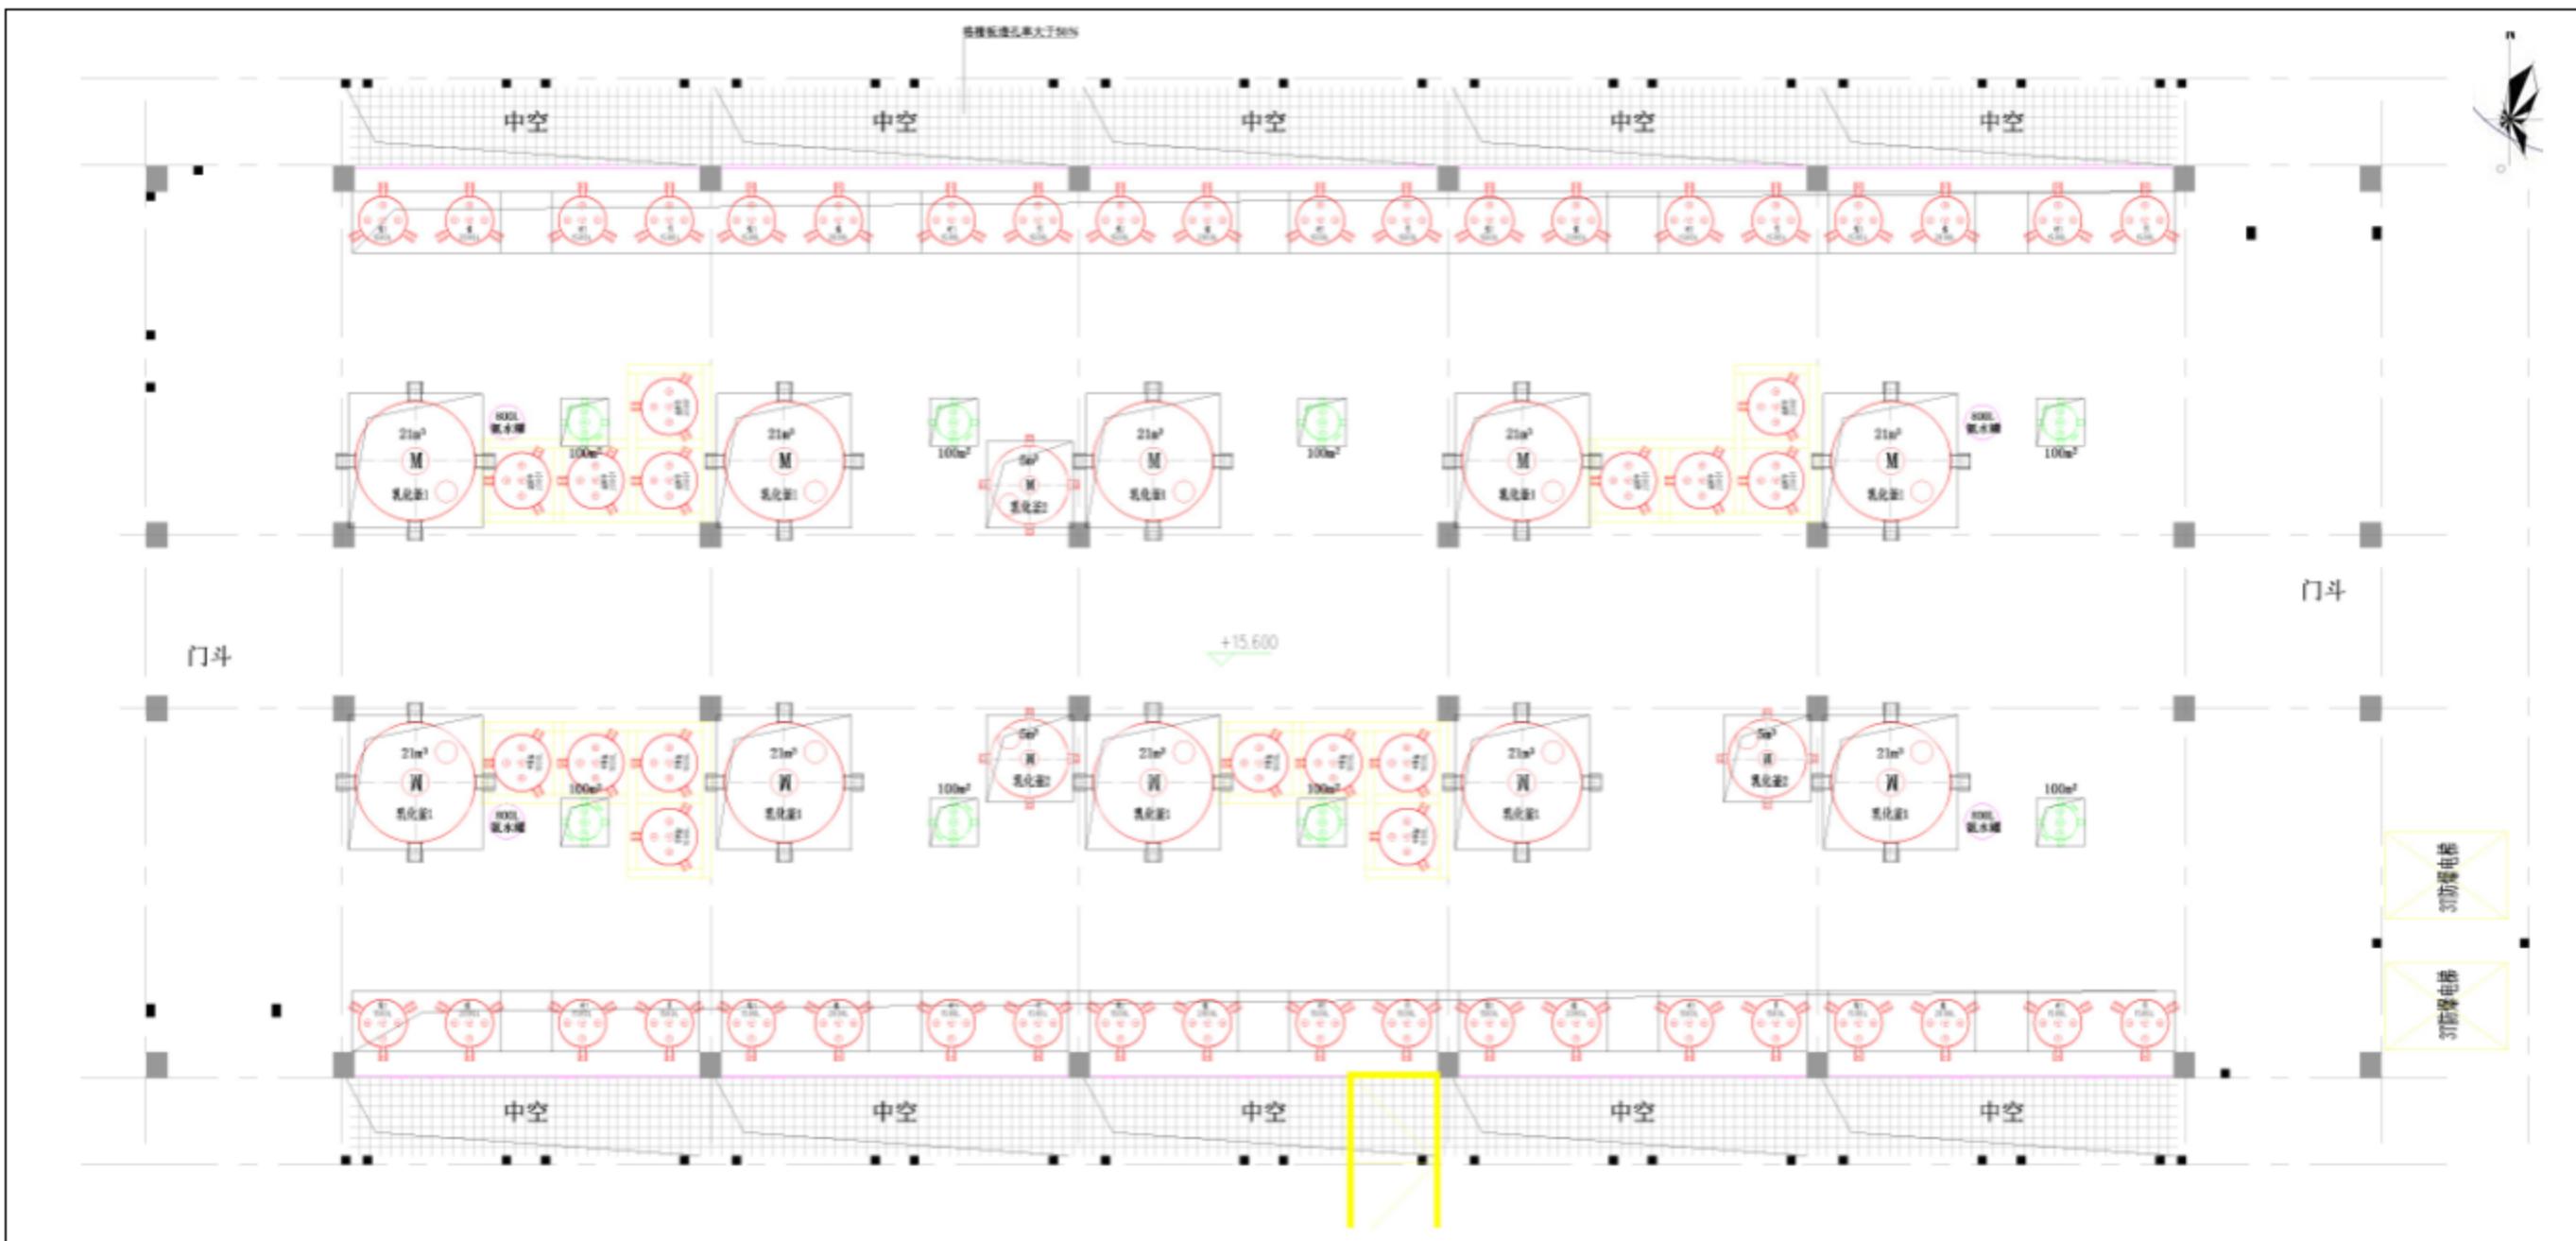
甲类车间A4层平面布置图(比例尺1:100)
